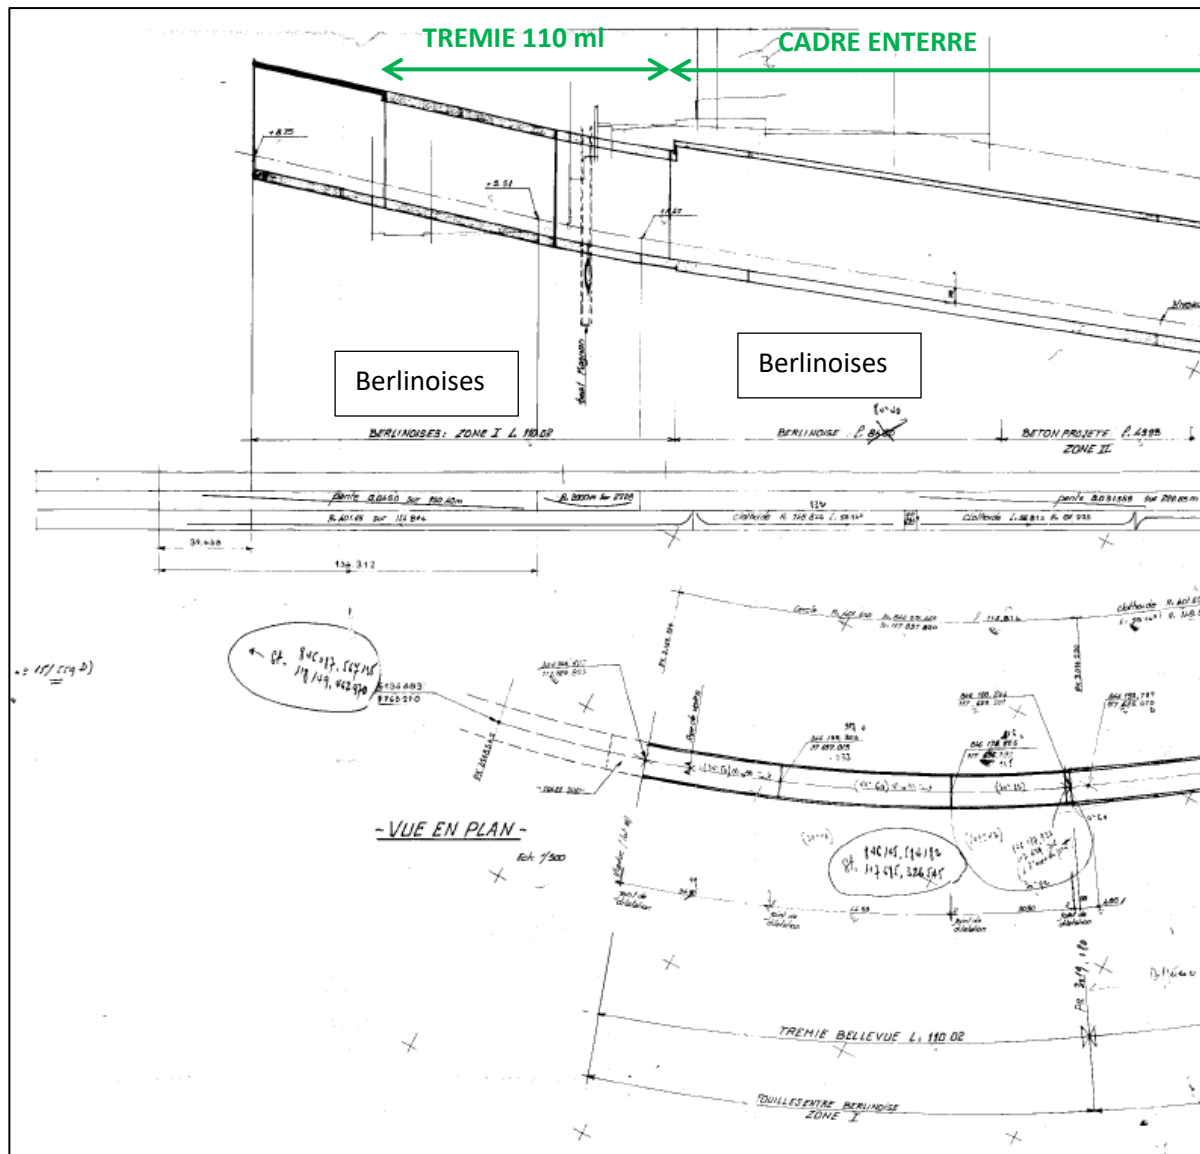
Extrait plan 450⁹ du 18/04/1984 – Dossier OUVRAGE RTM
